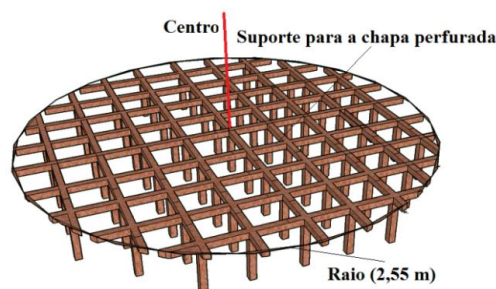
Detalhe do suporte ou engradamento para o fundo perfurado.
